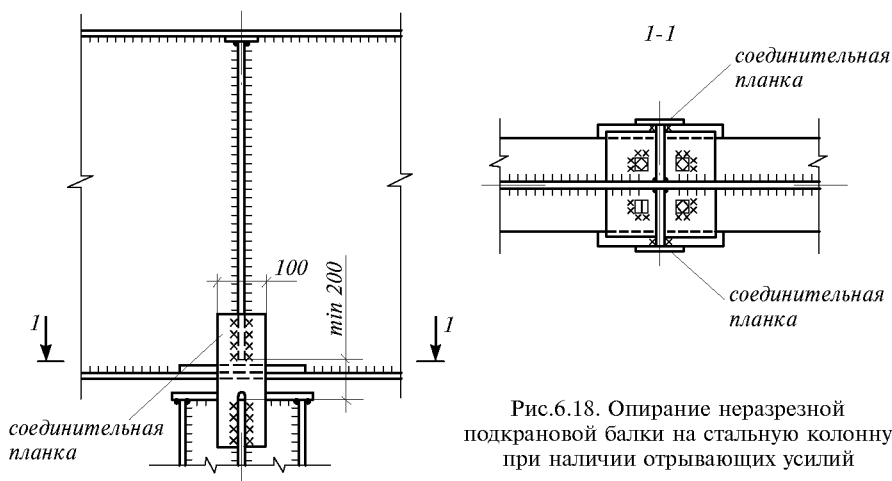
Опирание неразрезной подкрановой балки на стальную колонну при наличии отрывающих усилий
